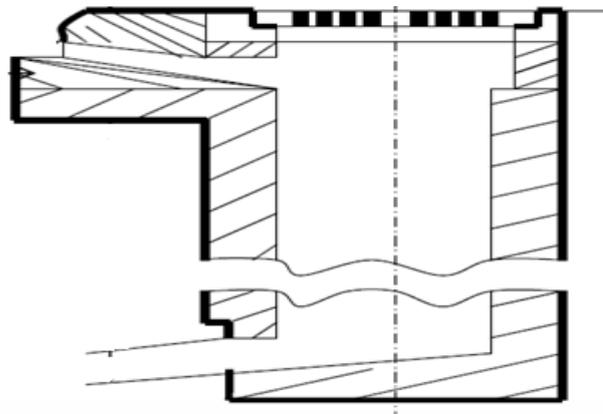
EXEMPLE D'UNE BOUCHE D'EGOUT
